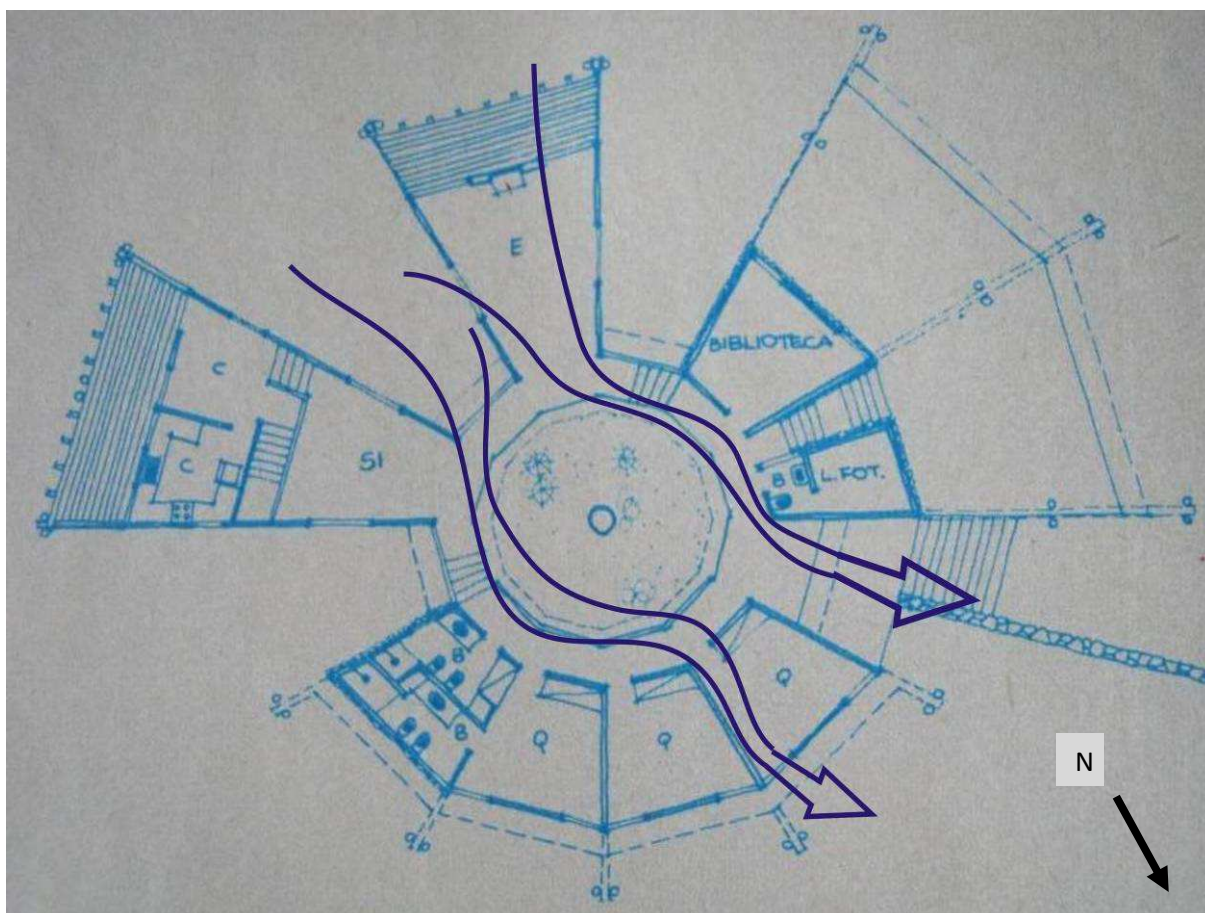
Planta do segundo pavimento: esquema da circulação do ar.
